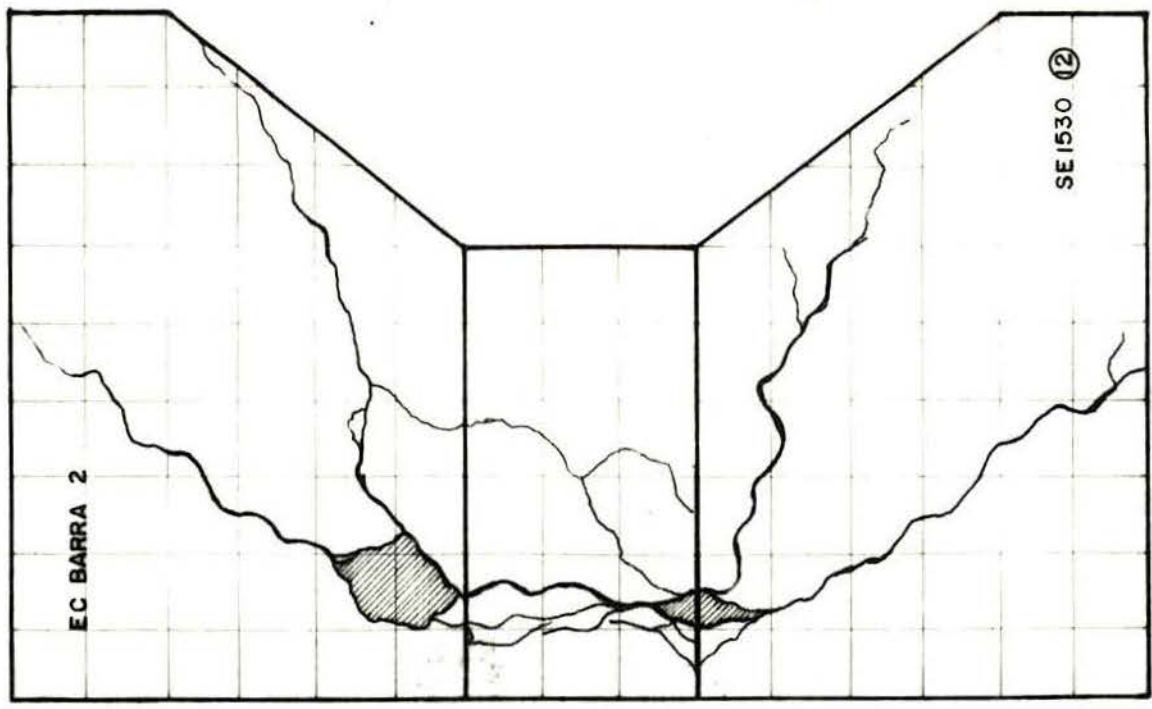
Fissuração dos CP SE1530
